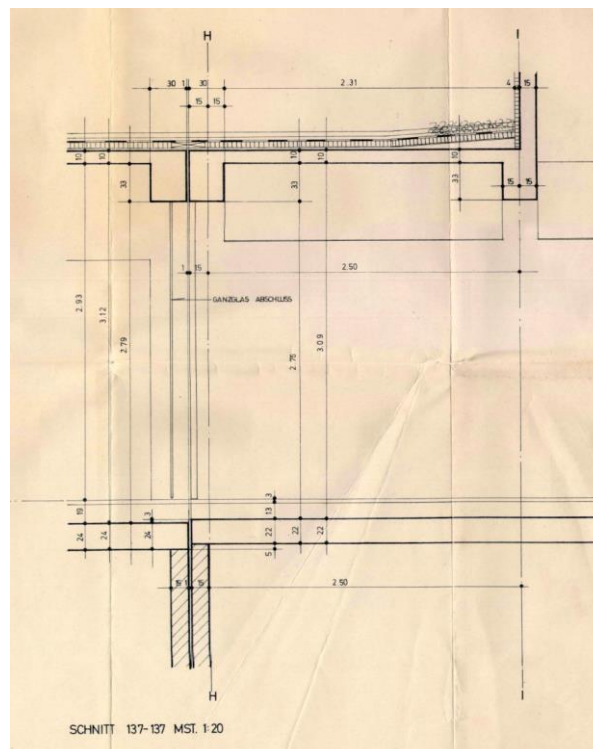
Schnitt 137 durch Decke über UG und EG (Lage siehe Bild 99), Planausschnitt Plan Nr. 147-128, E. Ulrich, 1972
